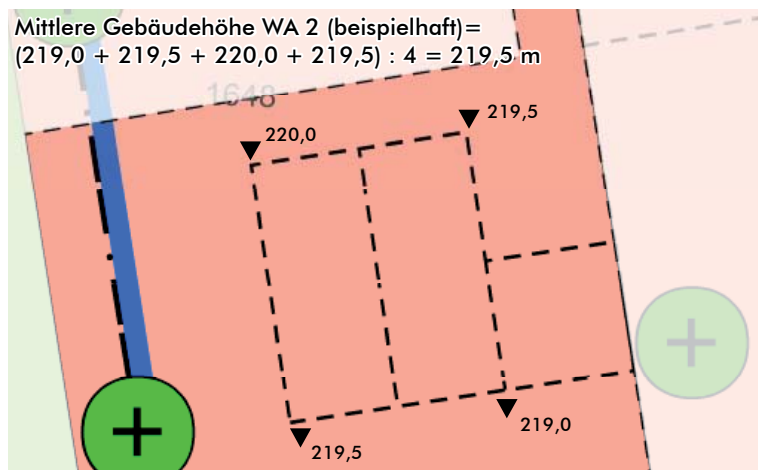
Schemagrundriss Unterer Bezugspunkt WH und GH im WA 2, unmaßstäblich
